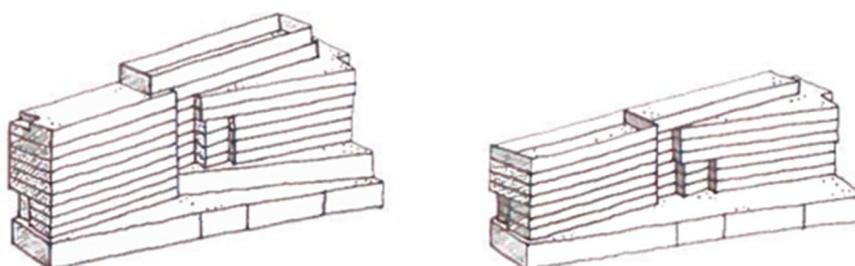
VARIANTES DE 26 M (DROITE) OU 40 M (GAUCHE), SOIT 6 OU 9 ÉTAGES, DE L'HÔTEL ISSY-LES-MOULINEAUX – SOURCE ÉTUDE D'IMPACT TOME A PAGE 19
